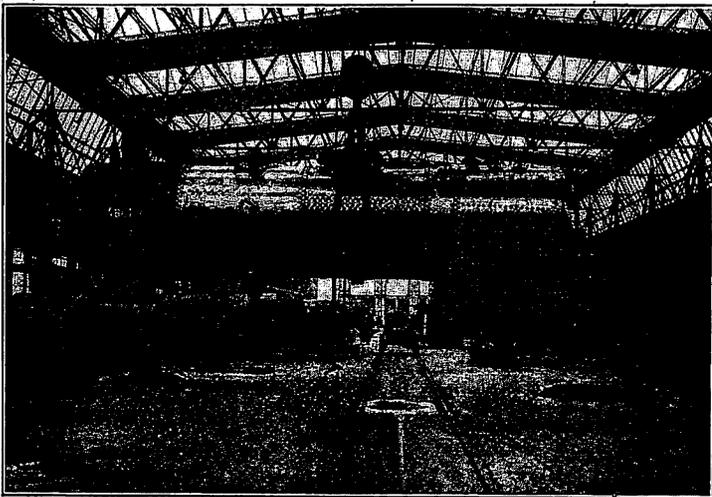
Kesselschmiede; Blick in der Längsrichtung.
